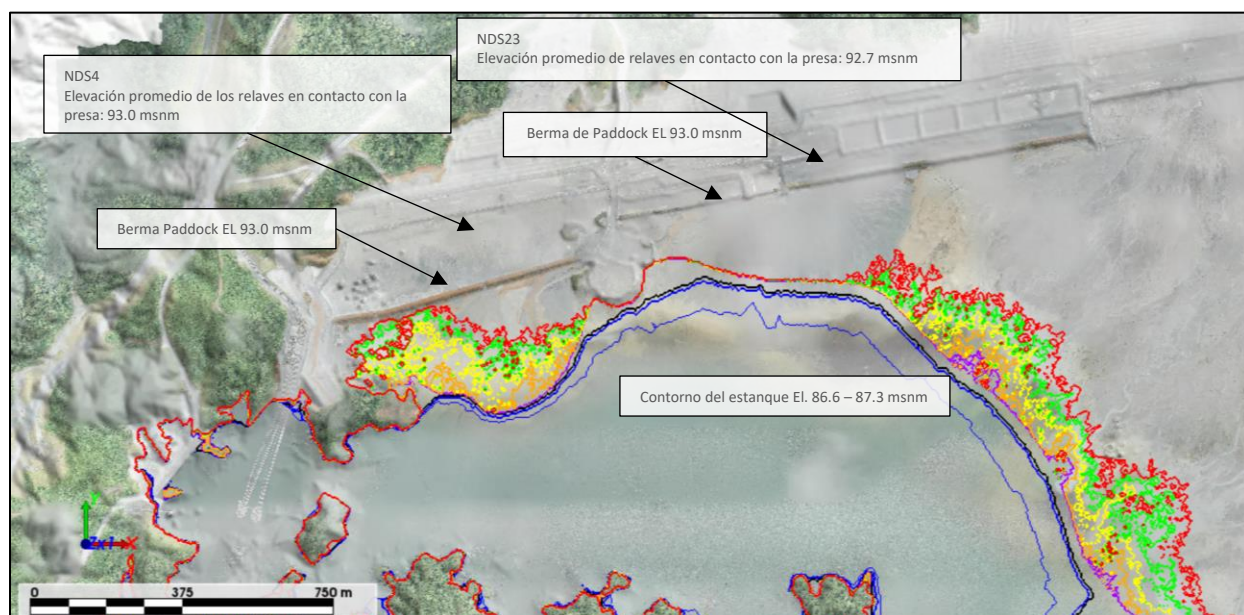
Vista en planta de la playa de relaves en N2-3 y N4
